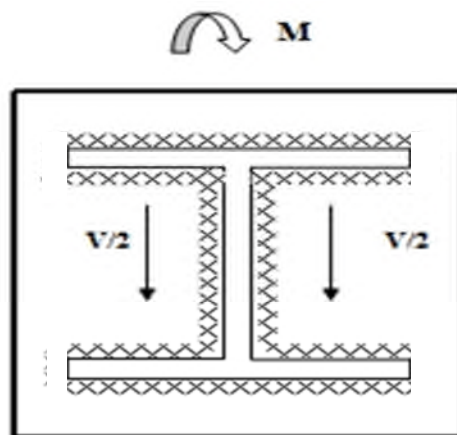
Assemblage platine poutre par cordon de soudure.
